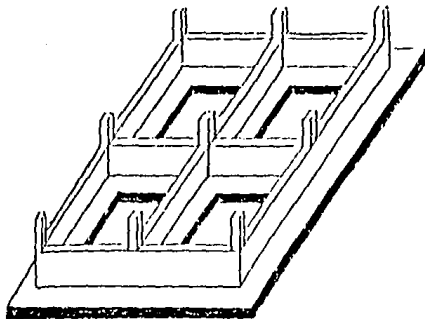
LOSA DE CIMENTACION FORMADA POR ZAPATAS CORRIDAS
